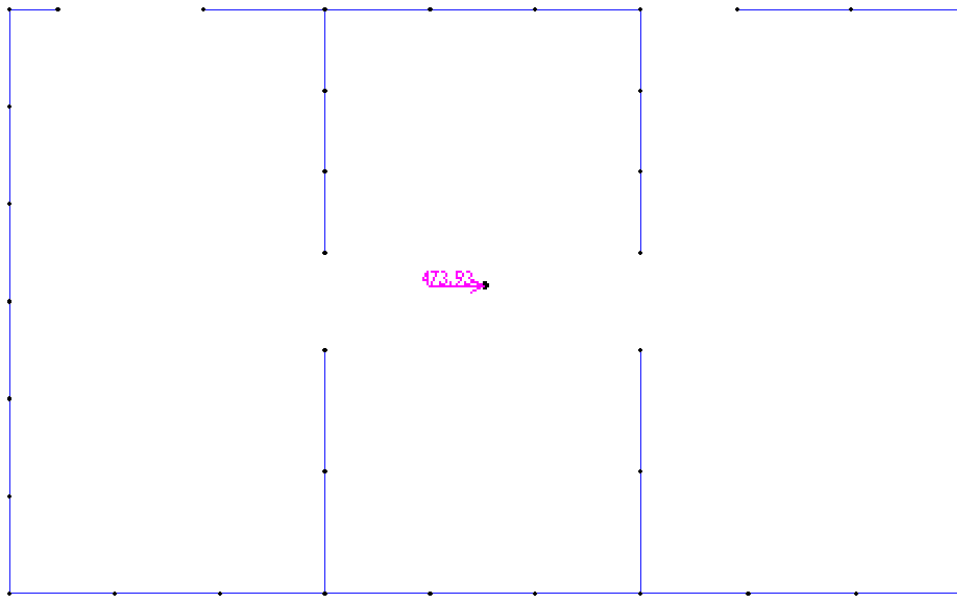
Vista en planta del modelo de SAP2000 para la casa 1
